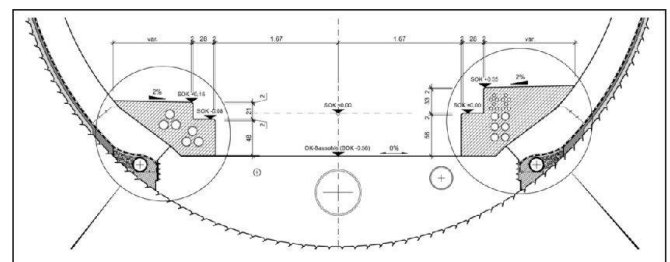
Ausschnitt Tunnelquerprofil mit Rohrblocken in Banketten.
